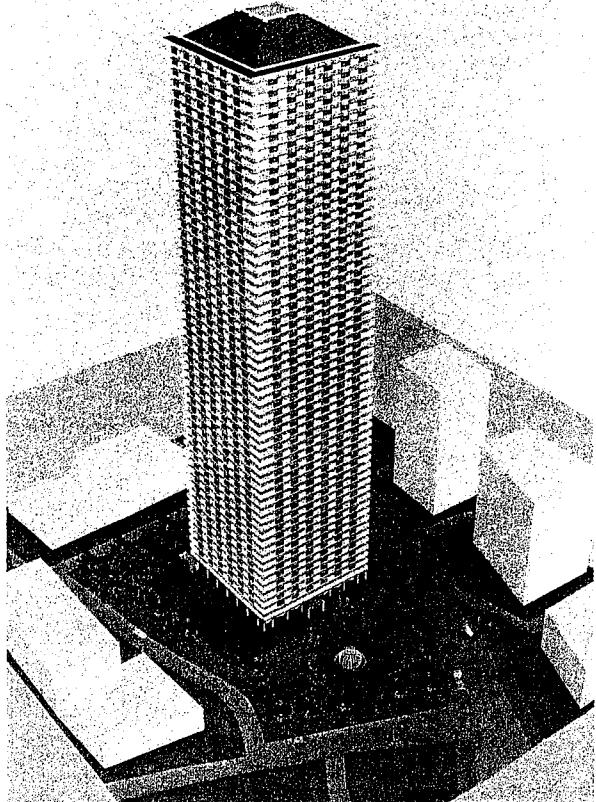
60階建て純ラーメン構造集合住宅鳥瞰図
